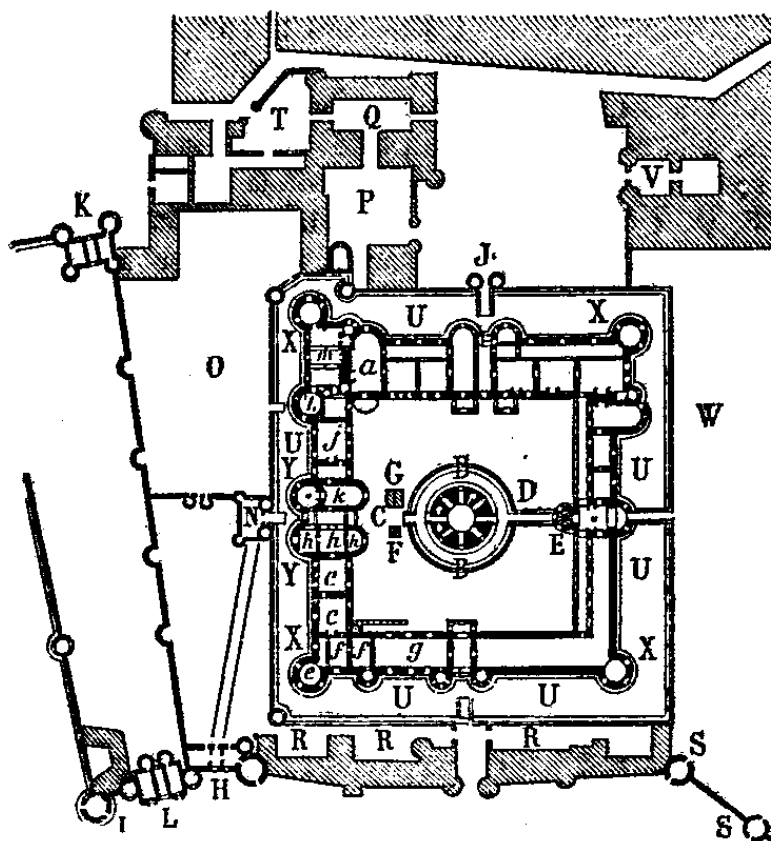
Plan du rez-de-chaussée du château du Louvre au temps de Charles V.
